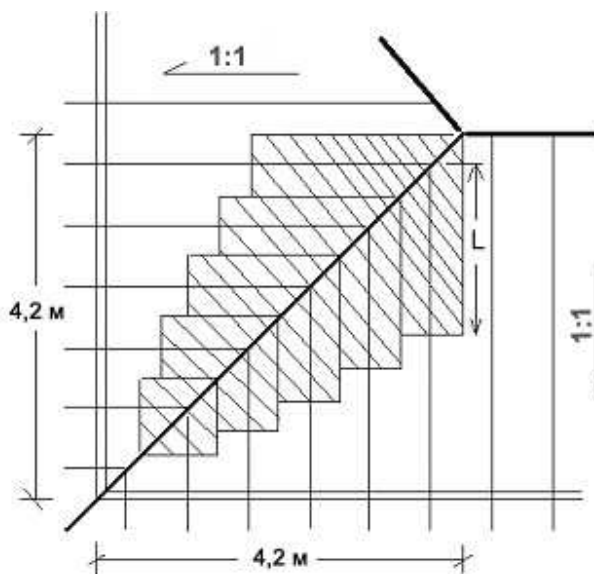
План крыши, схема углового стропила и грузовая площадь
